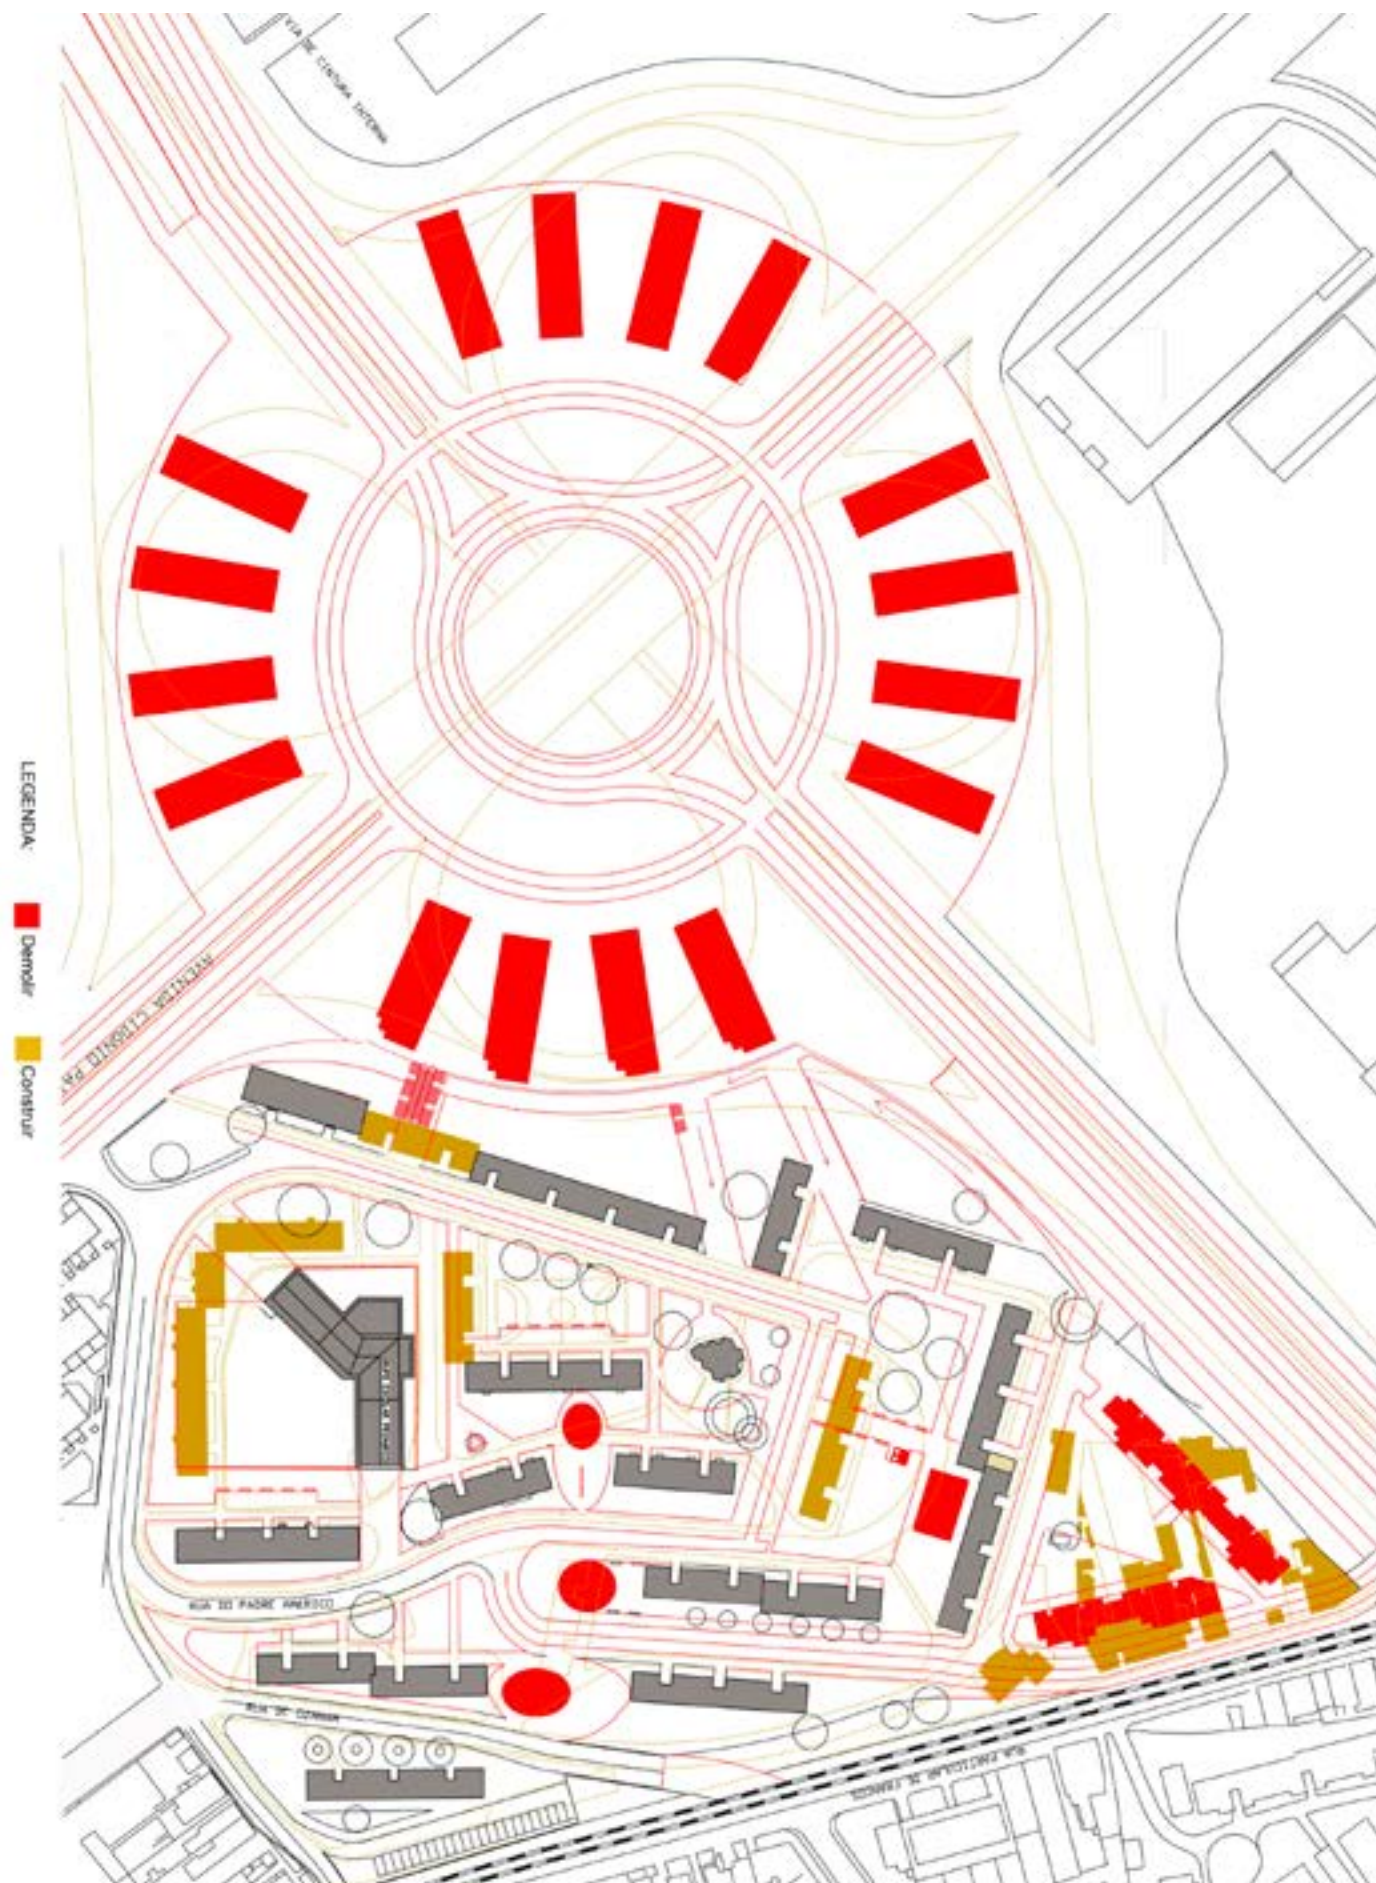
Planta Vermelhos e Amarelos - Proposta - Bairro de Francos
